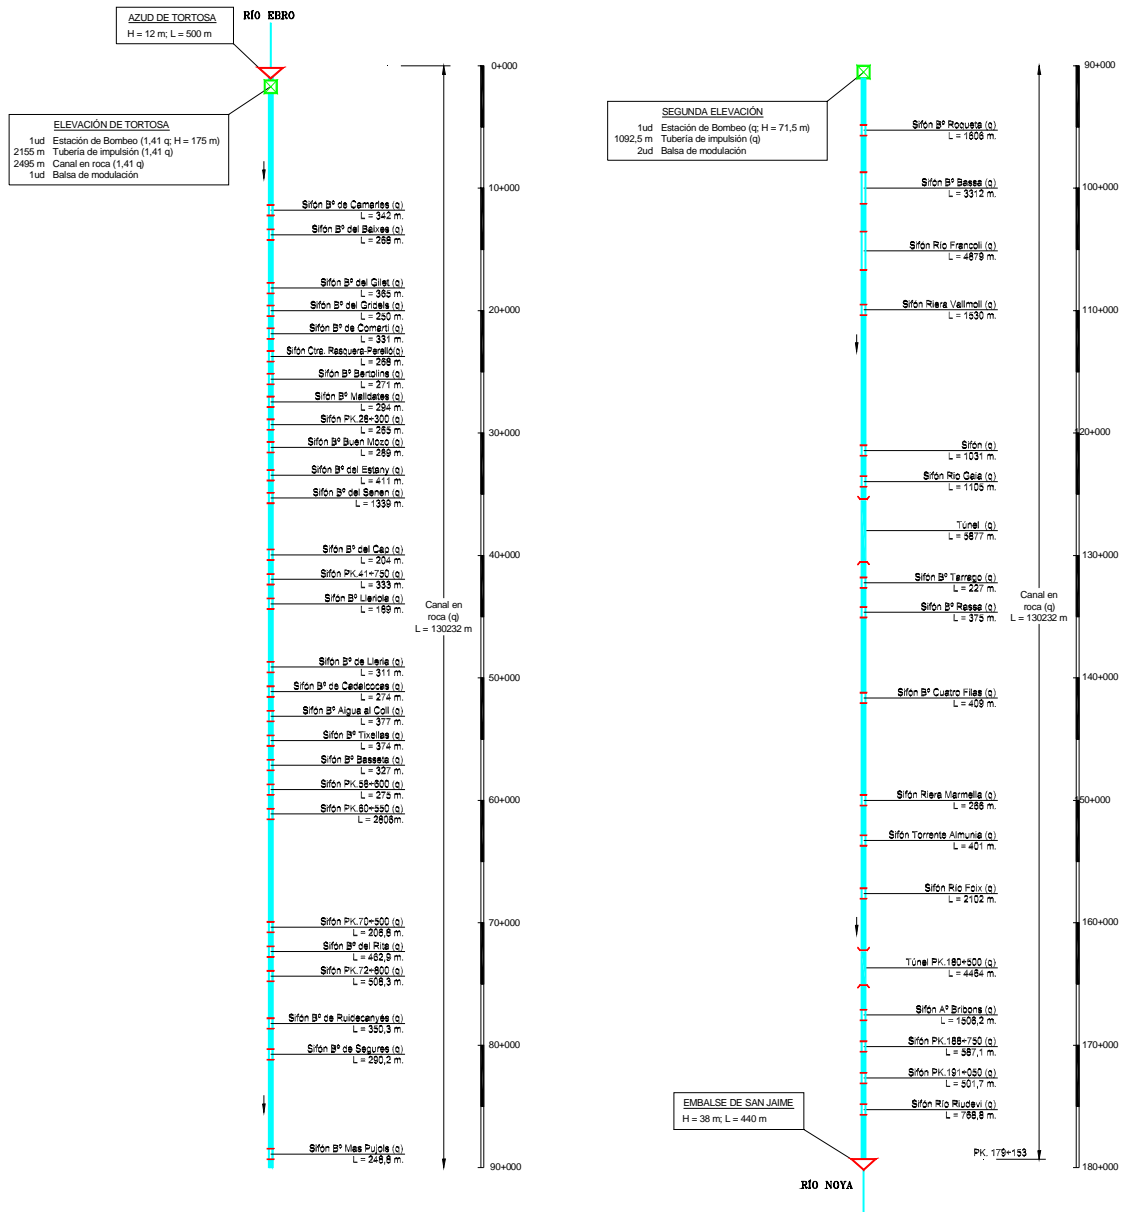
Conducción Ebro – Barcelona. Esquema en planta
